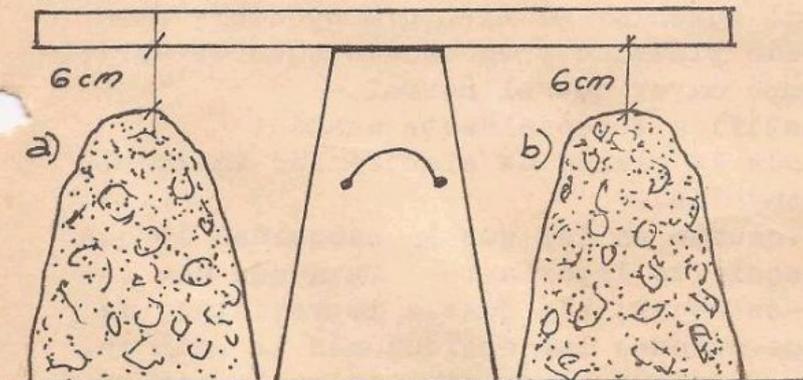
a) HORMIGÓN SIN ADITIVO
